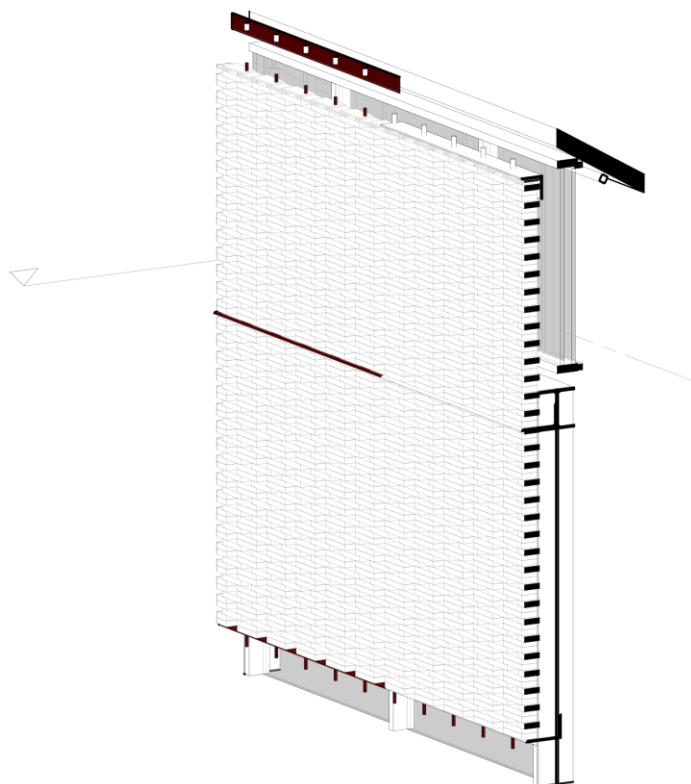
Pantalla de muro en celosía. Fuente: Propia.
